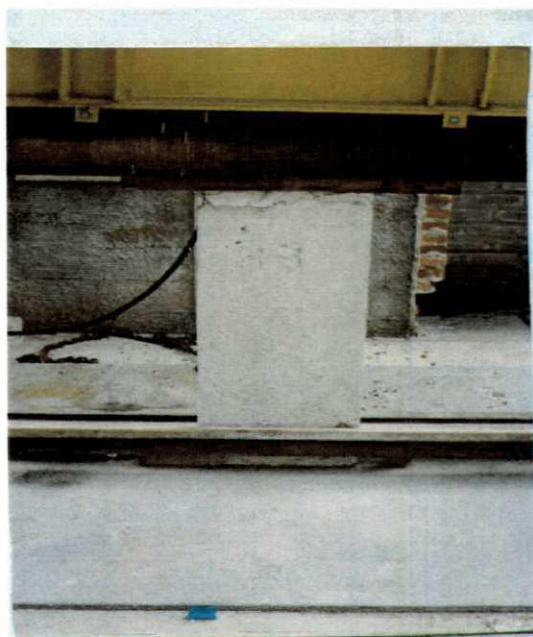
Ensaio de rompimento à compressão da placa de argamassa armada com casca de arroz.
